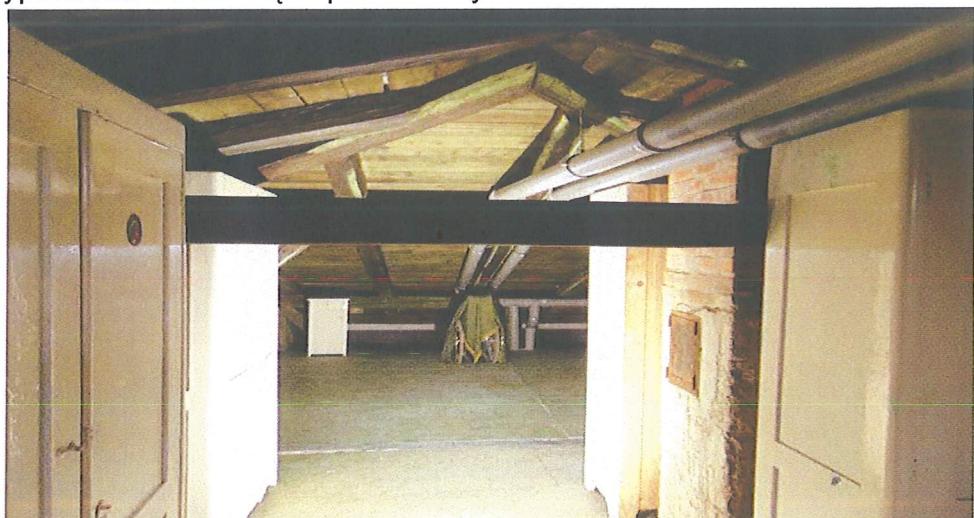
Wnętrze strychu. Widok w kierunku zachodnim.
